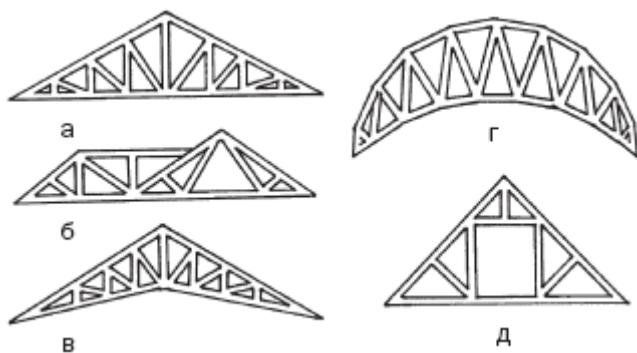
Конструкции ферм: а – двускатная; б – ферма со сложной формой верхнего пояса; в – ферманожницы; г – сводчатая; д – мансардная
